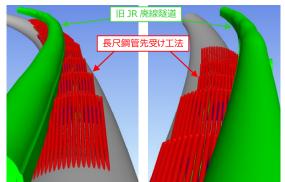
廃線隧道交差部 補助工法 3 次元モデル 3)
